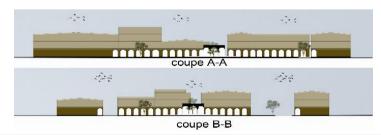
Coupe sur les parois de la place fait par l'auteur.
